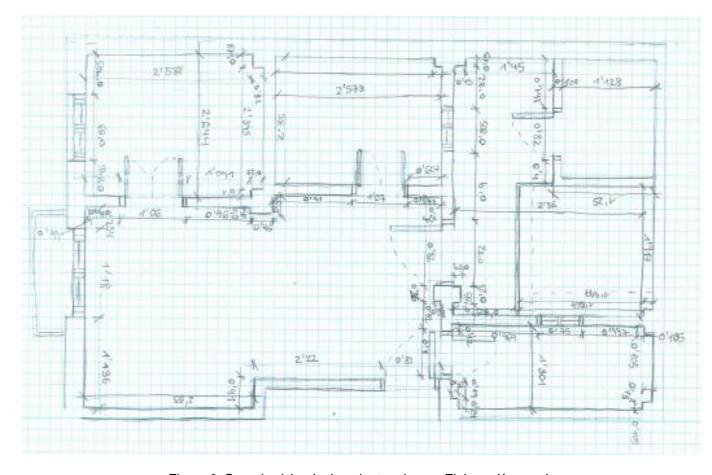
Croquis vivienda tipo planta primera. Elaboración propia
